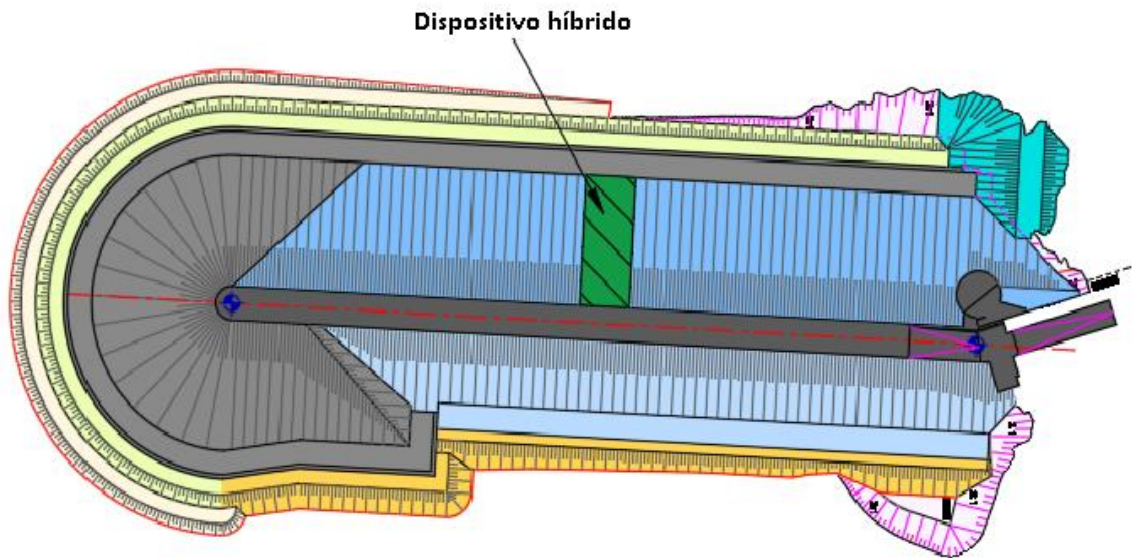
Vista em planta da solução projetada para o prolongamento do quebramar Norte do porto de Leixões com a secção onde vai ser integrado o dispositivo indicada.
